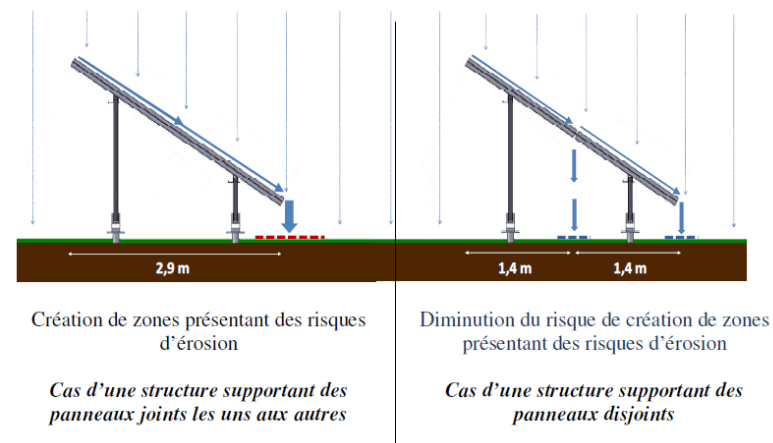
Structures porteuses supportant des panneaux joints ou disjoints
